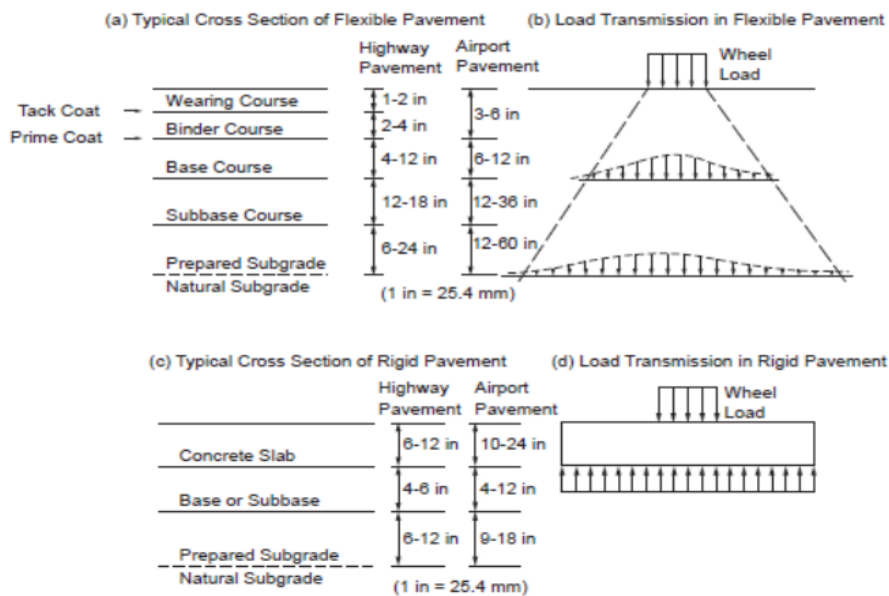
Transmisión de esfuerzos en pavimento flexible y rígido
